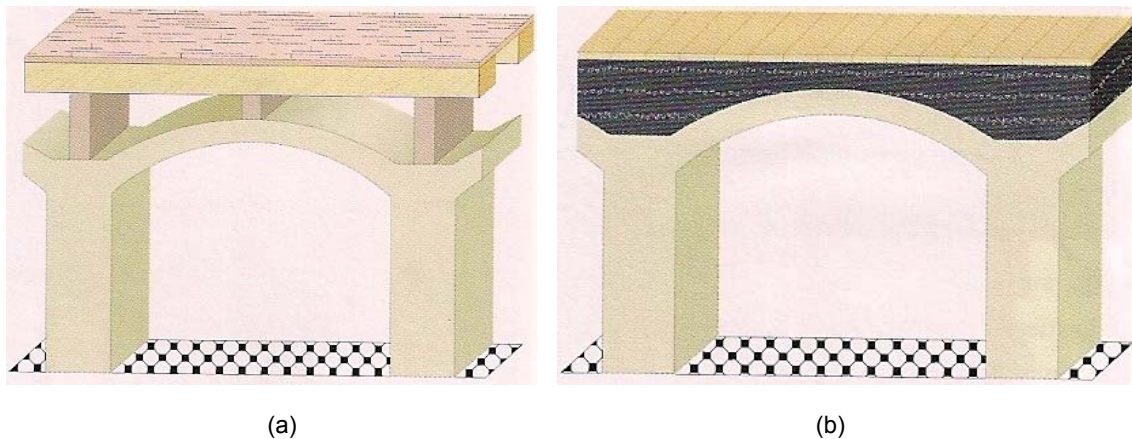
(a) Pavimento em arcos com estrutura em madeira que recebe soalho (b) Pavimento em abóbadas com enchimento que recebe revestimento de pedra ou cerâmico [1].
